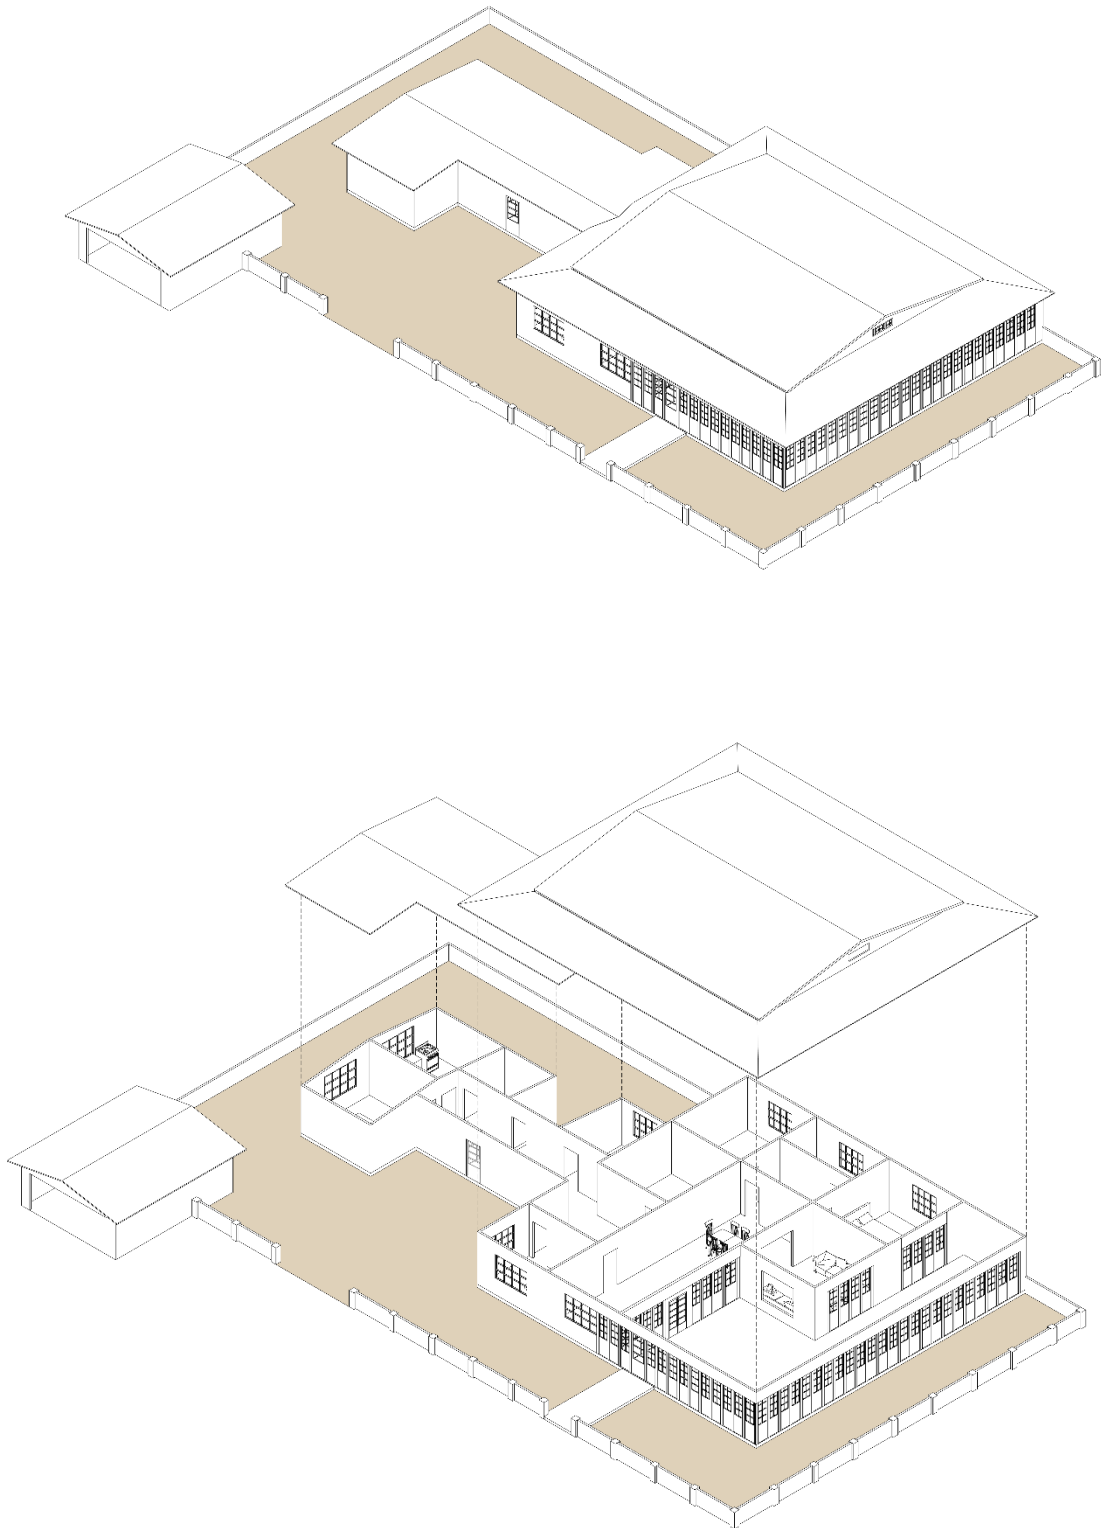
Axonometría del proyecto, Casa galería tipo 2, Barrio Inglés.
